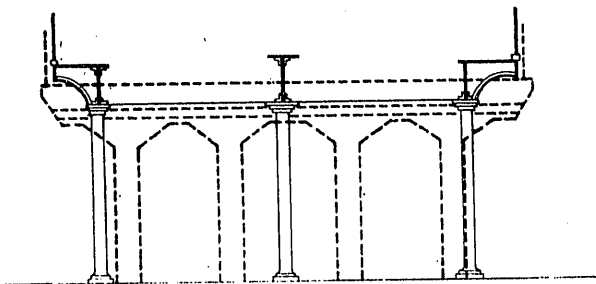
Sustrucción de los tramos metálicos del paso inferior de Loyola por losas de hormigón armado.
